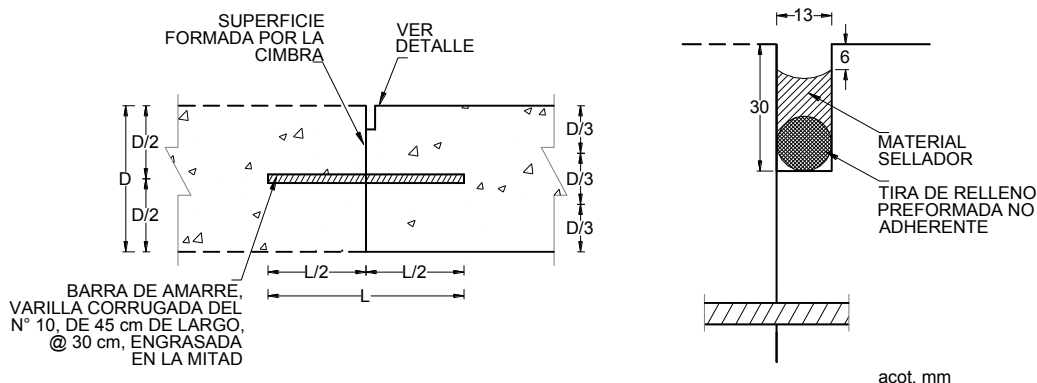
Corte y sellado de juntas longitudinales de construcción (Tipo B) con barras de amarre
